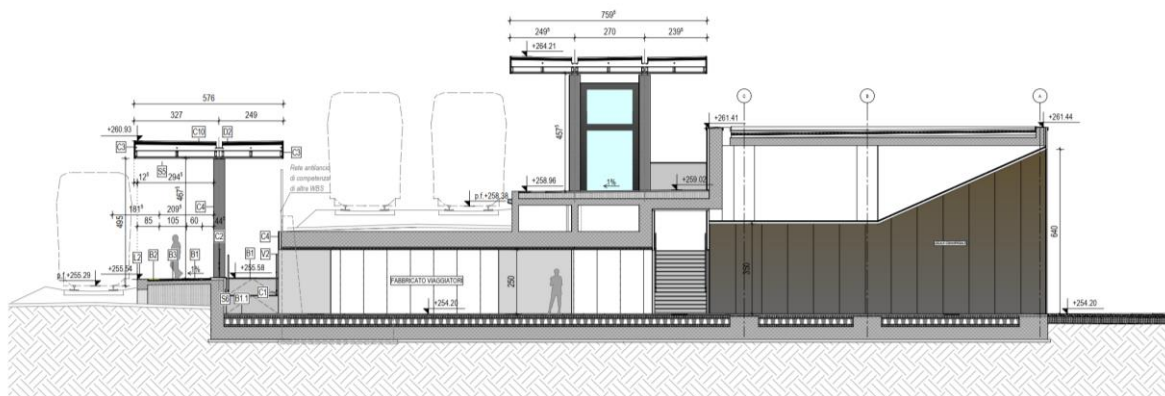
Stazione di Dittaino – Sezione trasversale fase provvisoria
